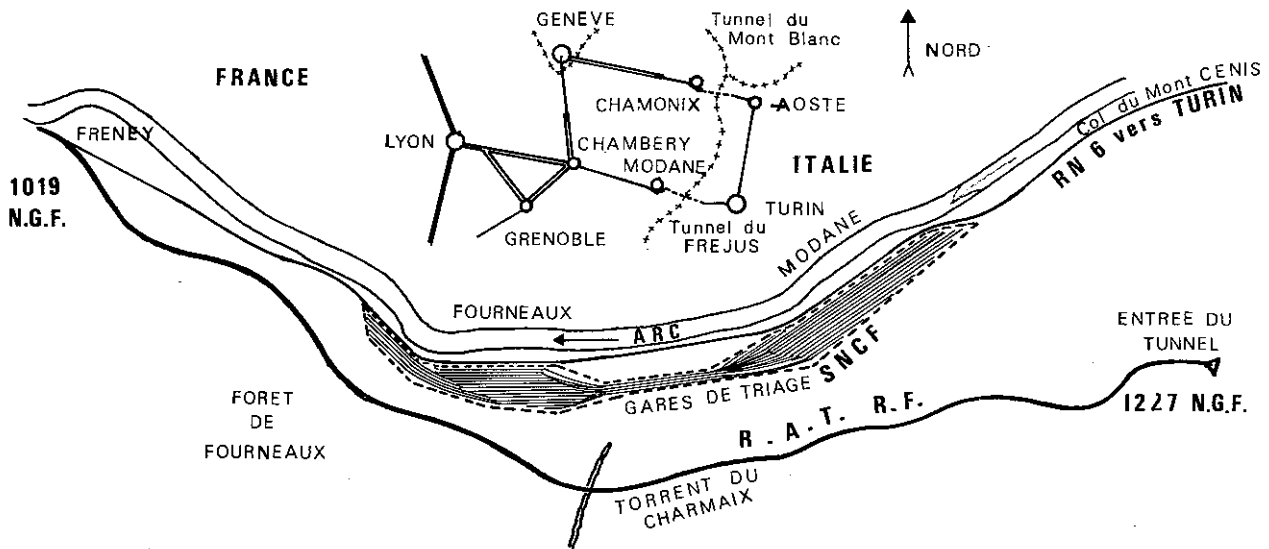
Plan de situation de la Route d'Accès au Tunnel Routier du Fréjus
